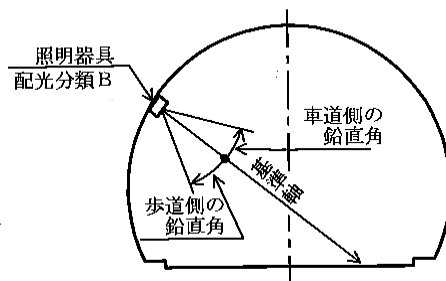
基準軸、鉛直角、方向（車道側・歩道側）
